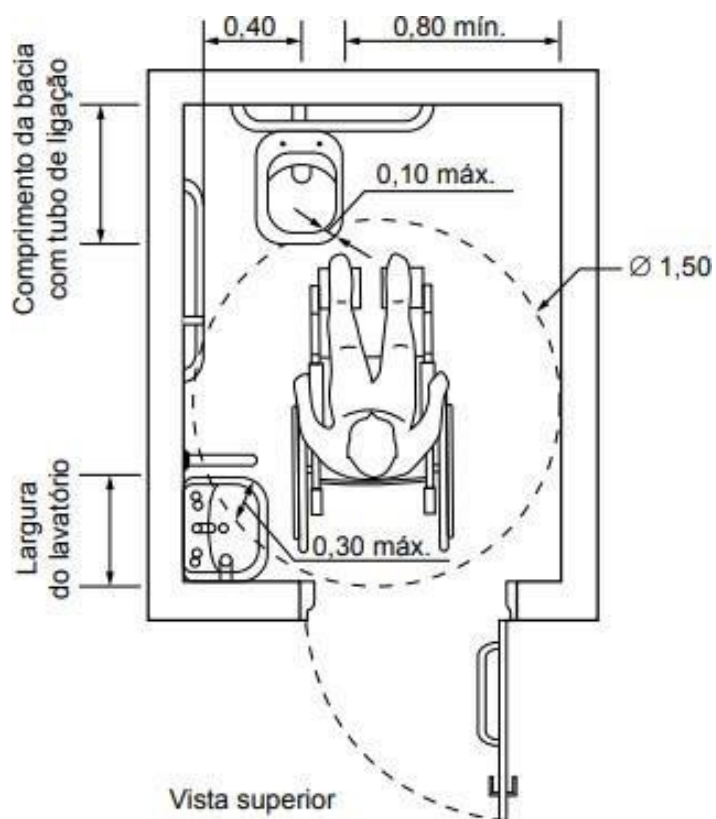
Medidas mínimas de um sanitário acessível, dimensões em metros.
